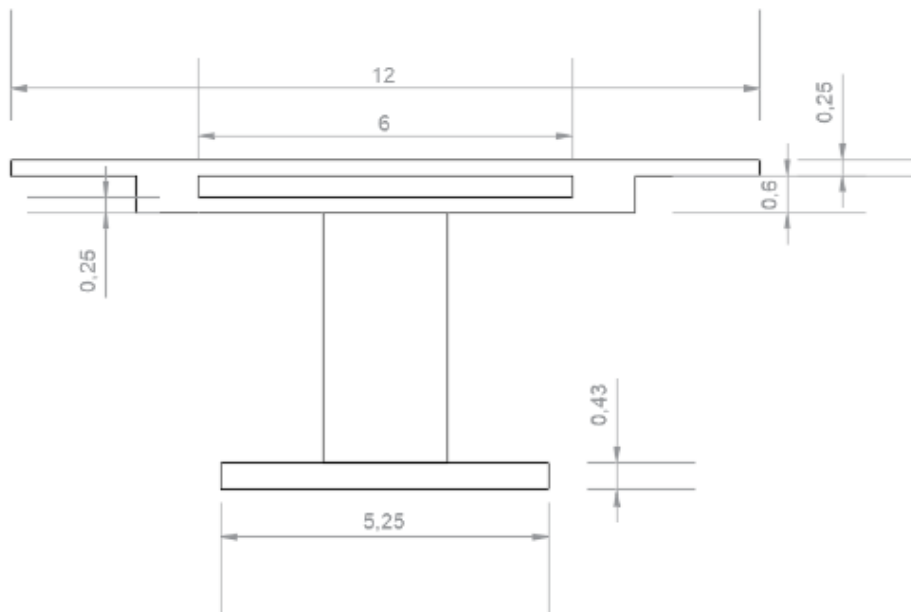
Sección transversal del puente con rigidez a torsión predominante en tablero
